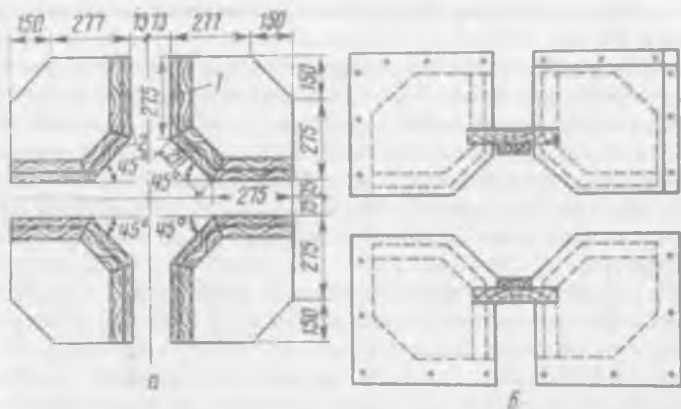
Схема установки заглушек для изменения сечения колонн и отсечения стен от бетонируемых колонн:
